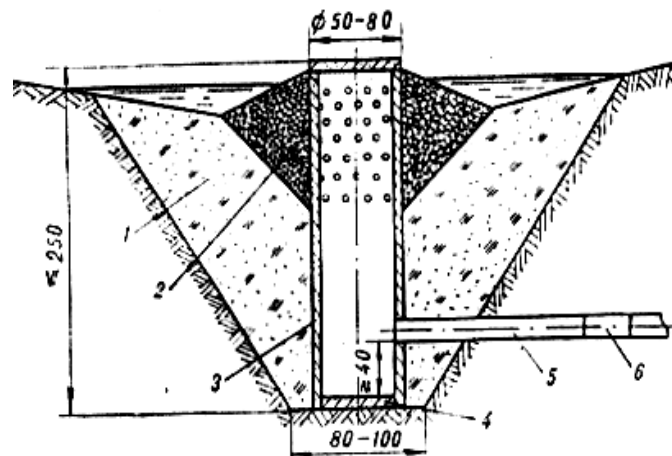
Поглотитель поверхностных вод из железобетонных колец: 1 – засыпка местным грунтом; 2 – гравий, щебень, мелкие камни; 3 – железобетонные кольца; 4 – бетонное днище; 5 – неперфорированная труба; 6 – дренажная труба
